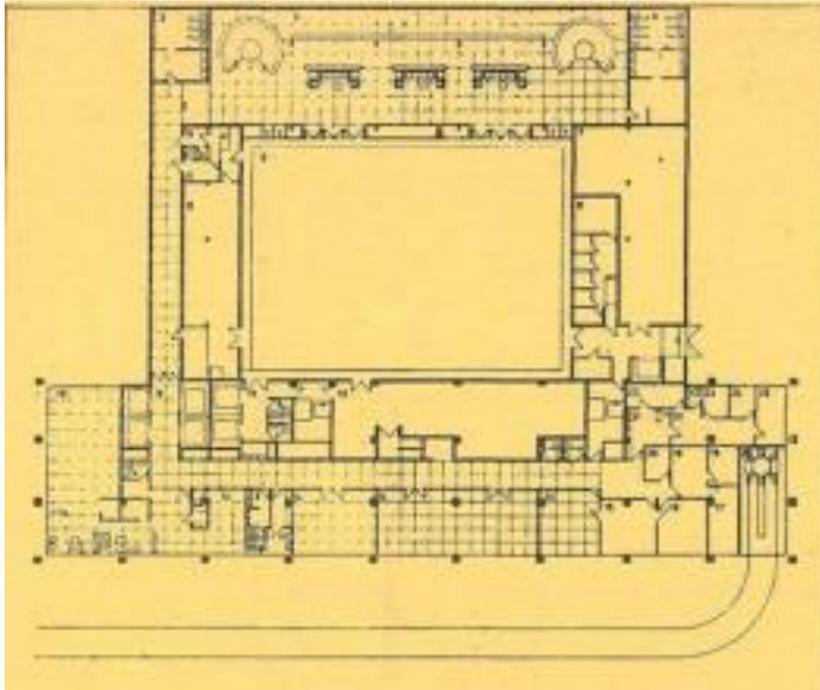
Planta do piso 1, Hotel Intercontinental, Frankfurt
